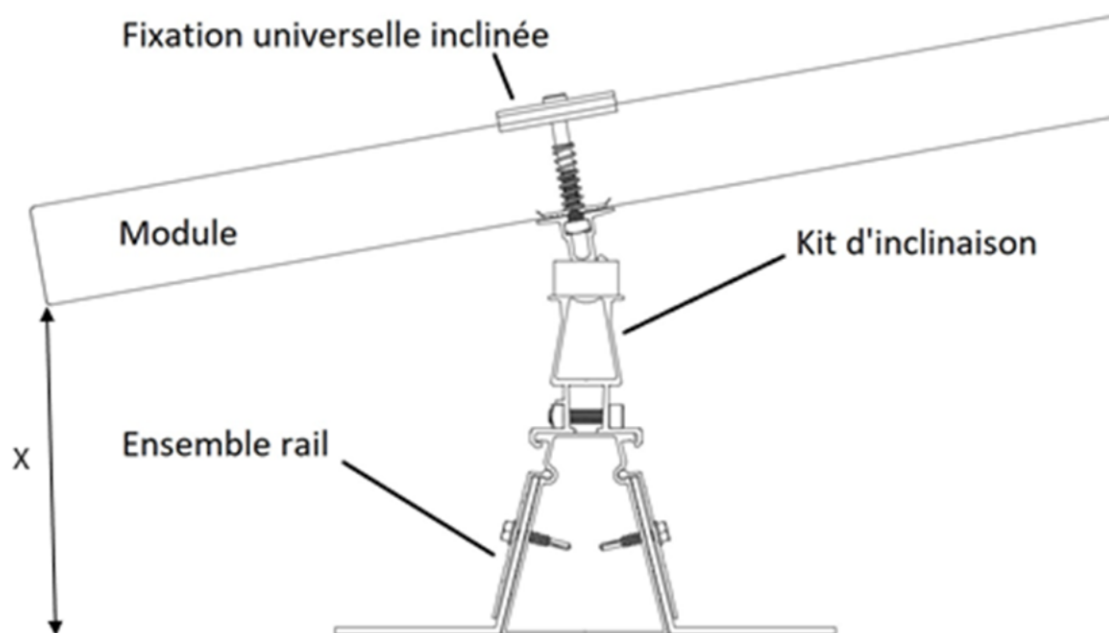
Assemblage rail / kit d'inclinaison (haut) / module
